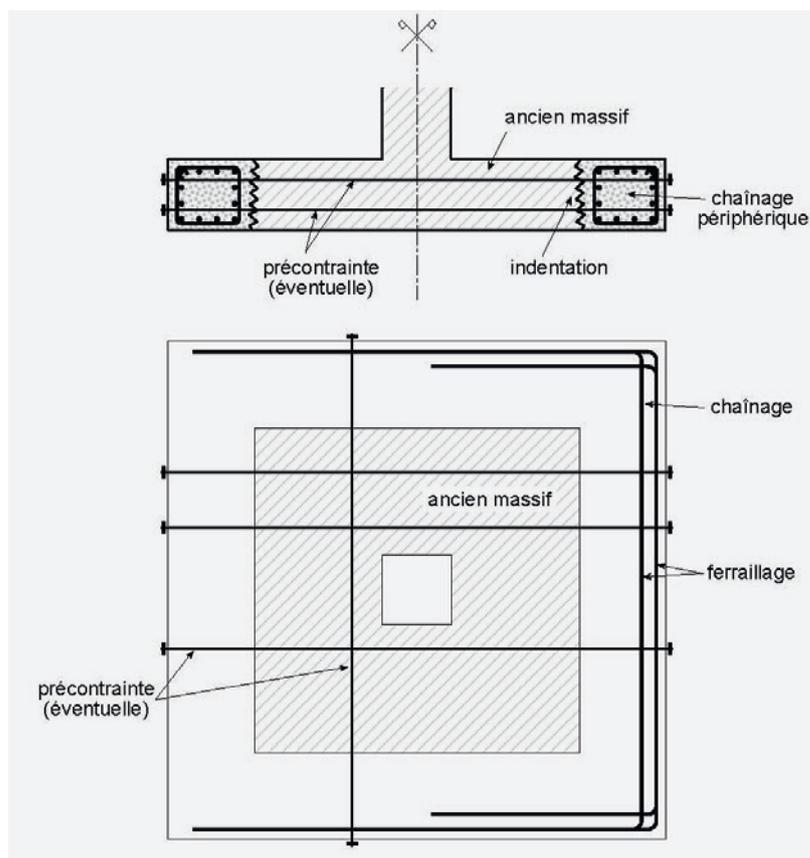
augmentation de la surface de la semelle sans surépaisseur.
